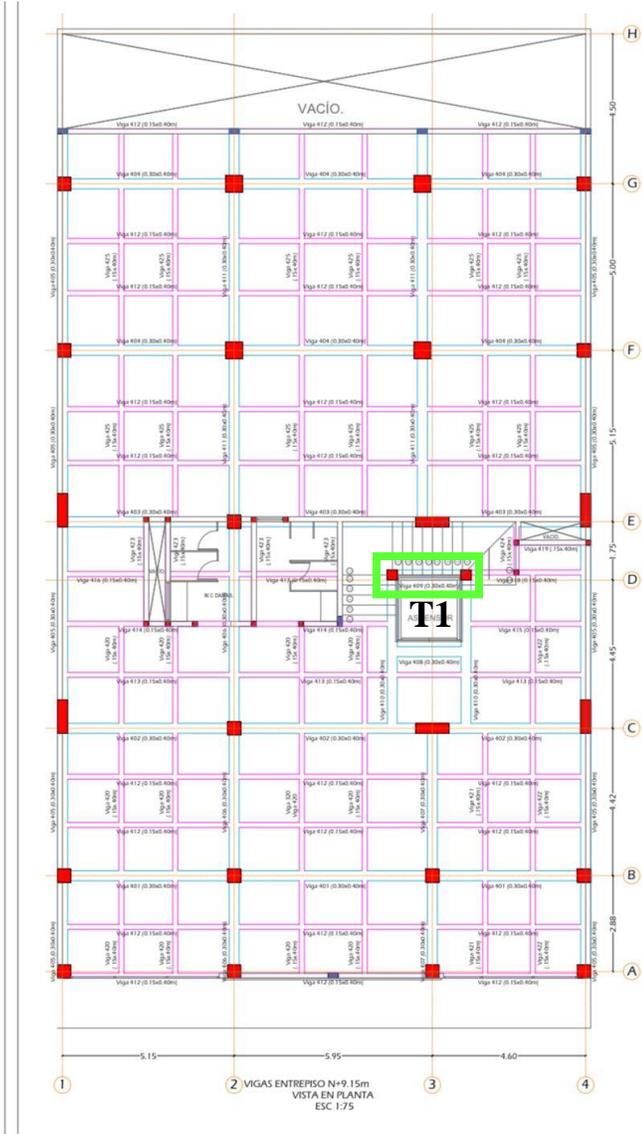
Columnas, vigas y columnetas vista en planta.
